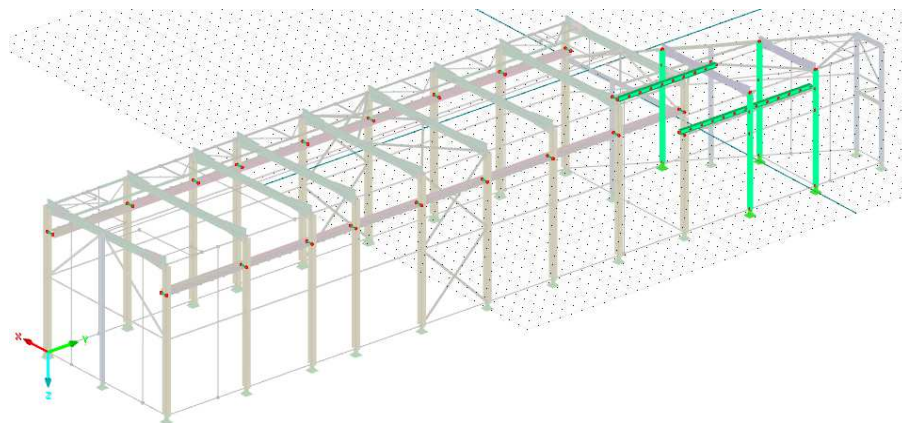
Geometrie konstrukce - RO101,6x4
